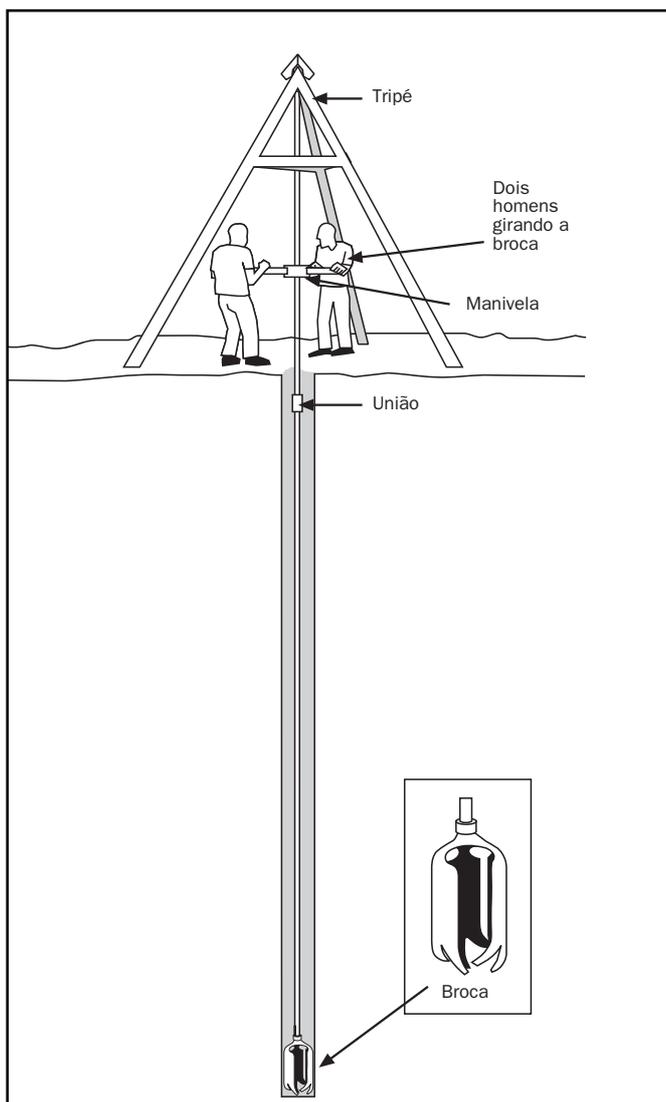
(c): Escavado (trado) (max. Profund.: 15m)
